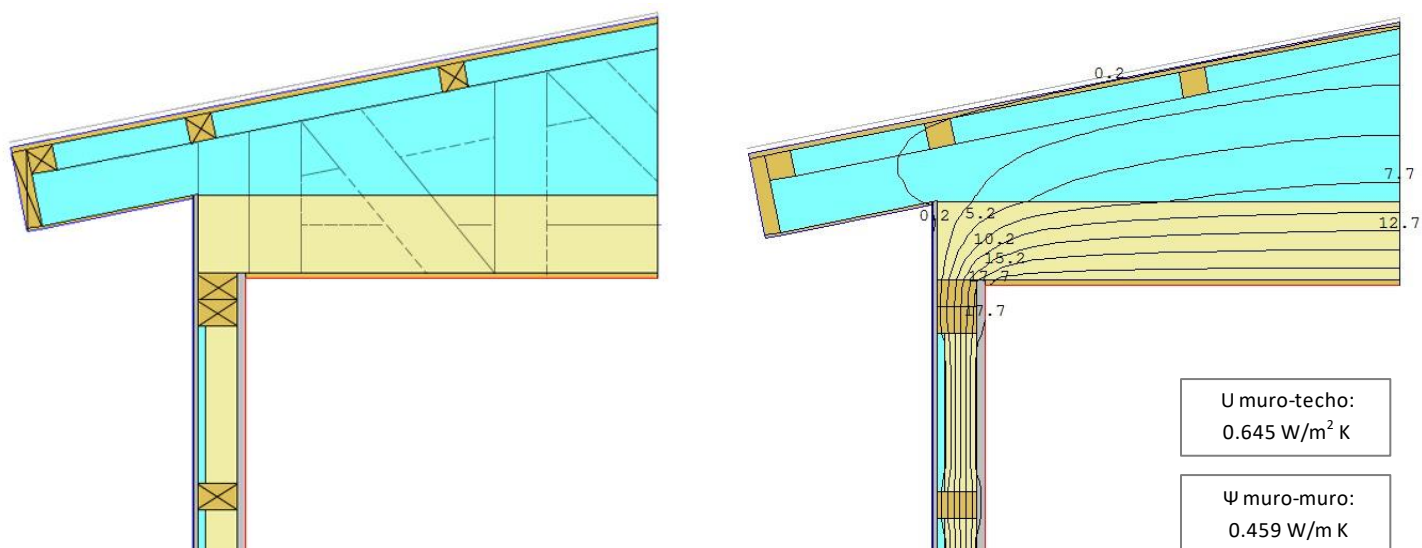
Detalle y diagrama de isotermas unión muro-techo, en vista de corte utilizando Muro Base
